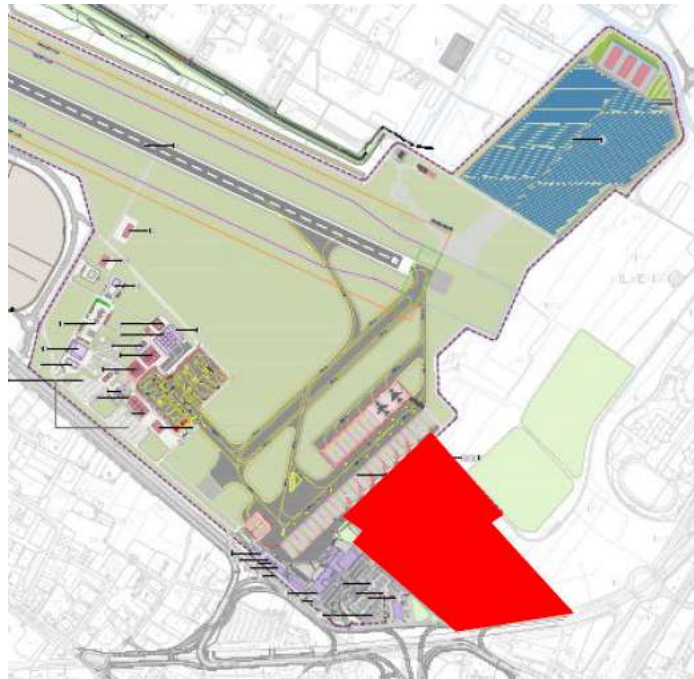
Ipotesi Masterplan con individuazione dell'area est
